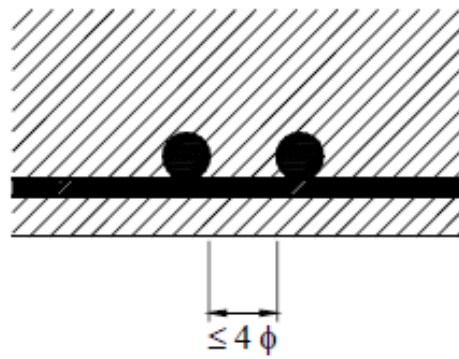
Espaçamento máximo entre duas barras emendadas por traspasse.
